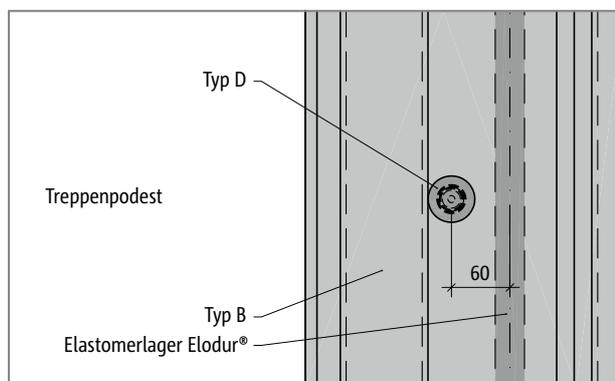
Schöck Tronsole® Typ B + Typ D: Detail A
